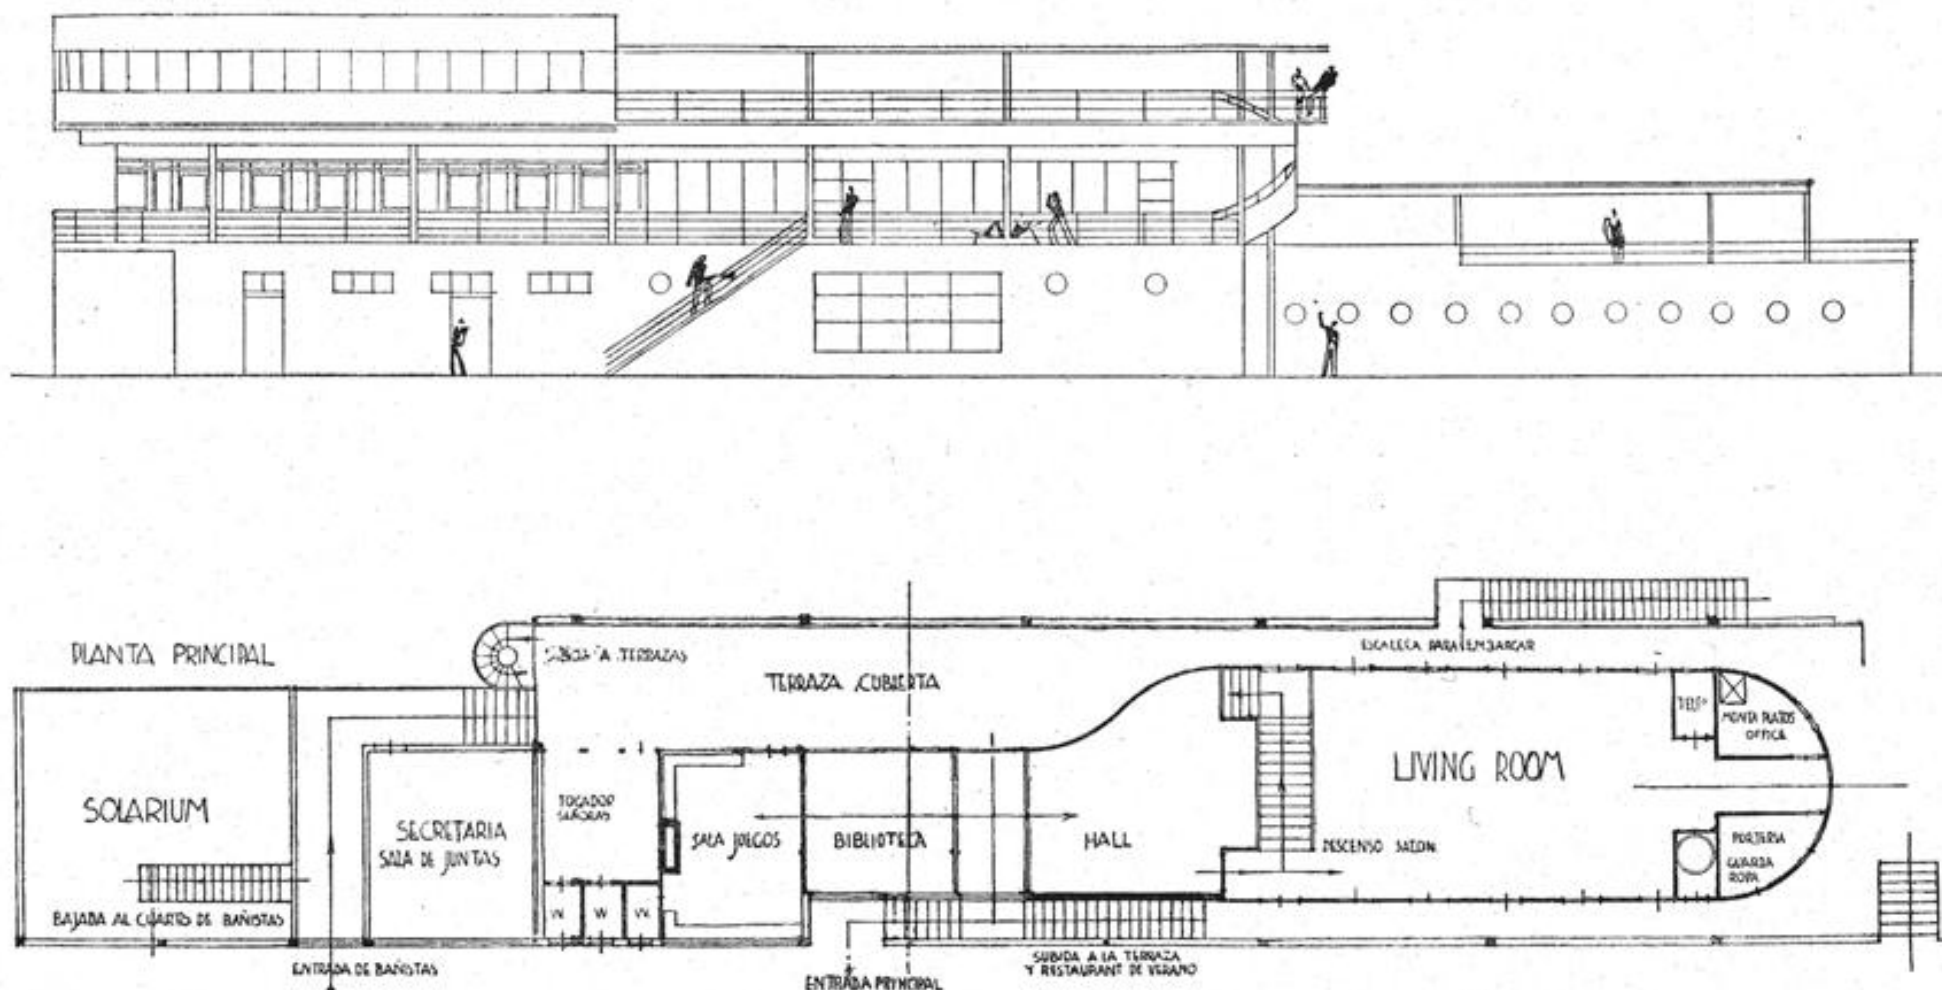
Alzado y Planta Arquitectónica de Club Náutico San Sebastián.
